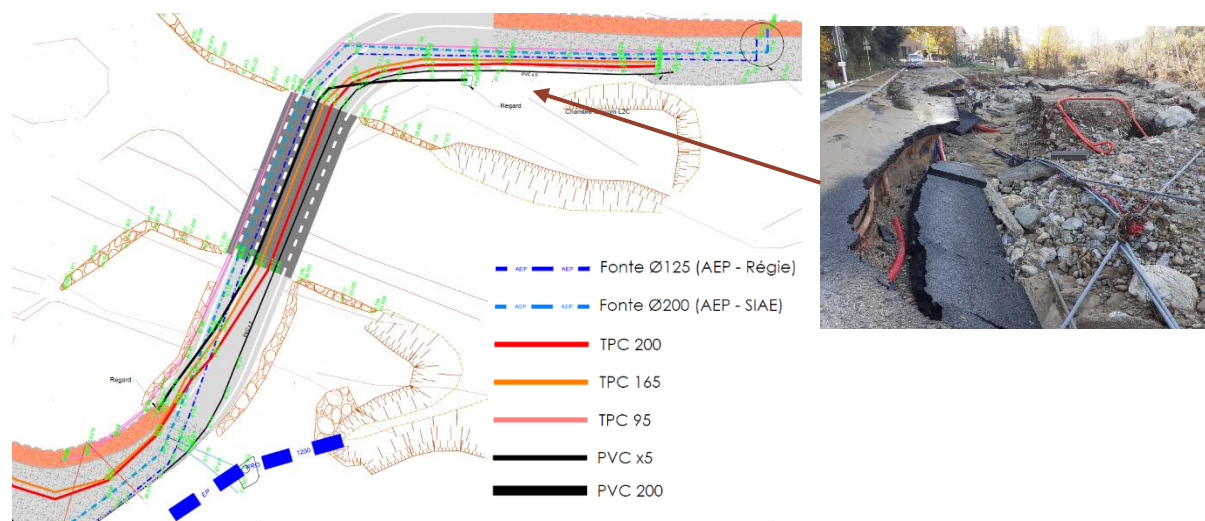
Plan de recollement des réseaux présents dans la fondation de l'ouvrage et état des ouvrages après la crue de novembre 2019
